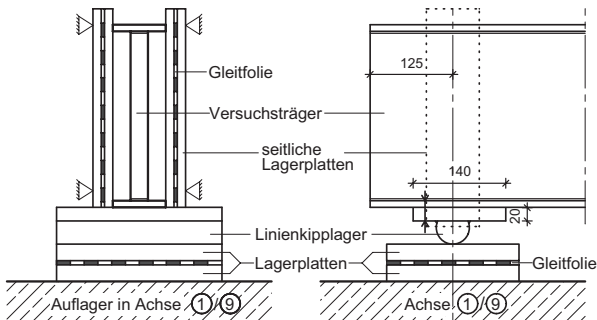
Detailausbildung der gelenkigen Auflagerpunkte
